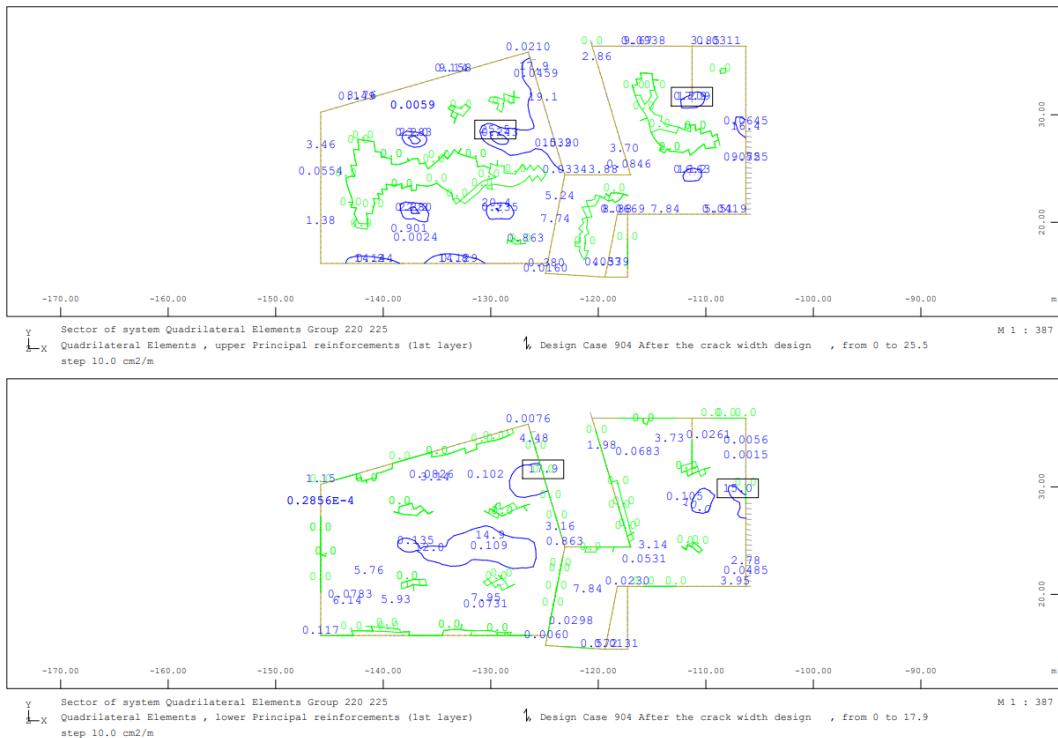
Armadura principal na face superior (sup.) e inferior (inf.) – laje intermédia – acesso Norte - ELS
